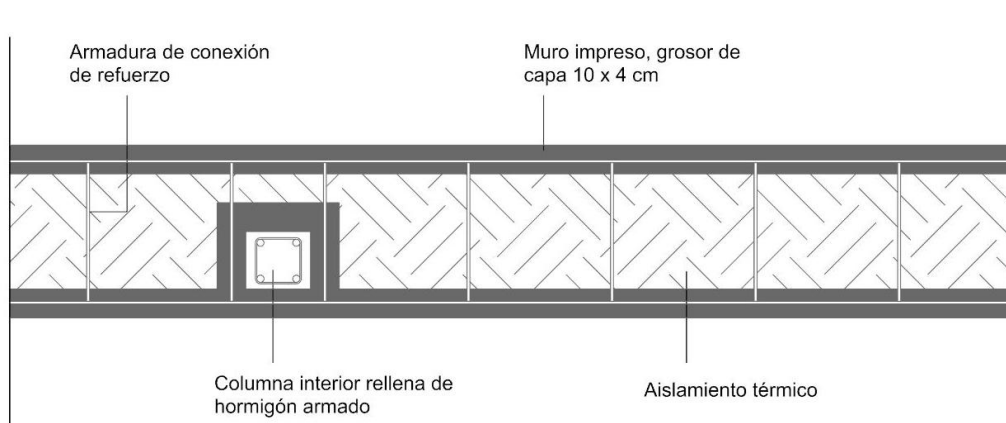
Detalle sección horizontal muro, construcción aditiva. E 1/20
